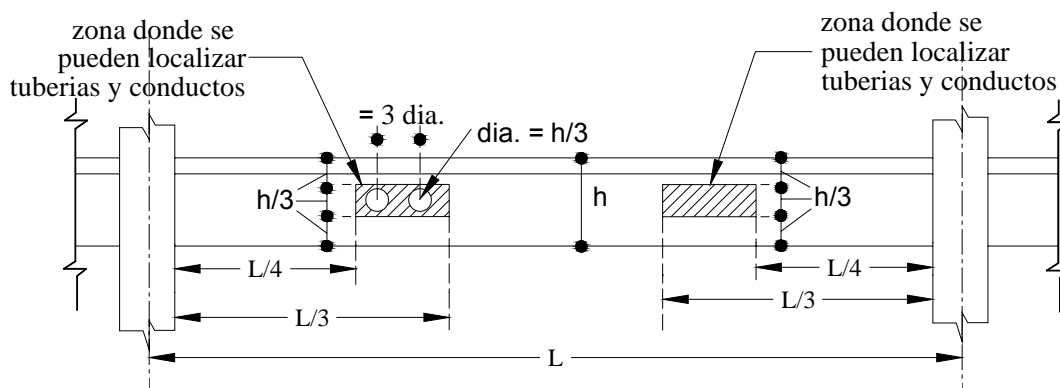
Localización de conductos y tuberías que atraviesan horizontalmente vigas, vigas maestras y viguetas. Adaptado de Essential Requirements for Reinforced Concrete Buildings¹.
